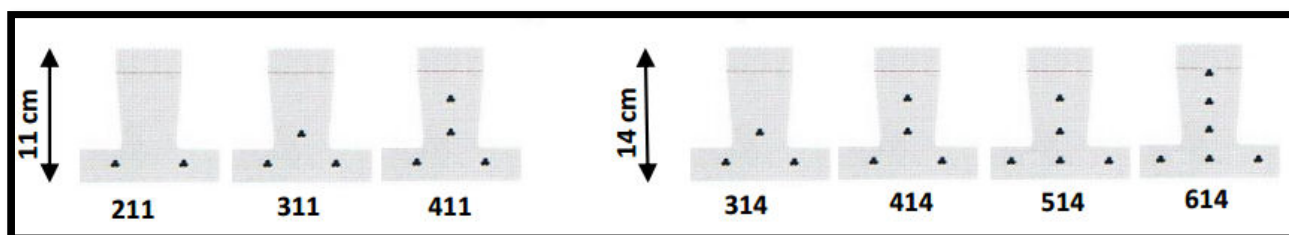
la hauteur des poutrelles.²⁹⁹
